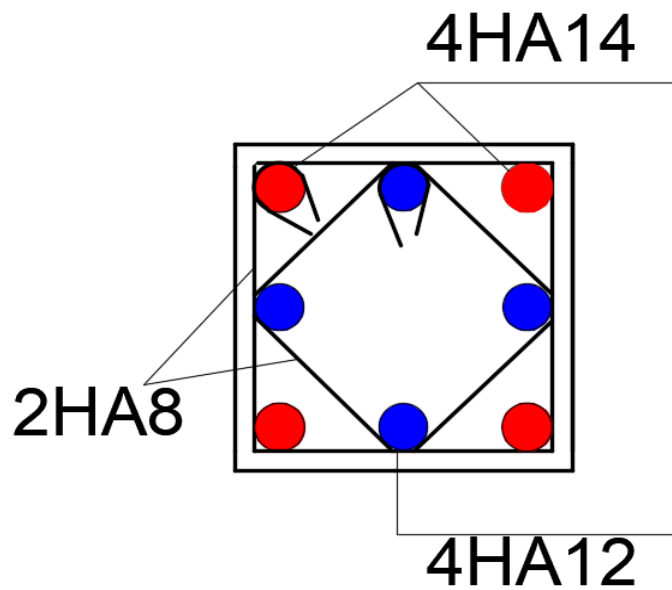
Ferrailage Poteau 35x35.
